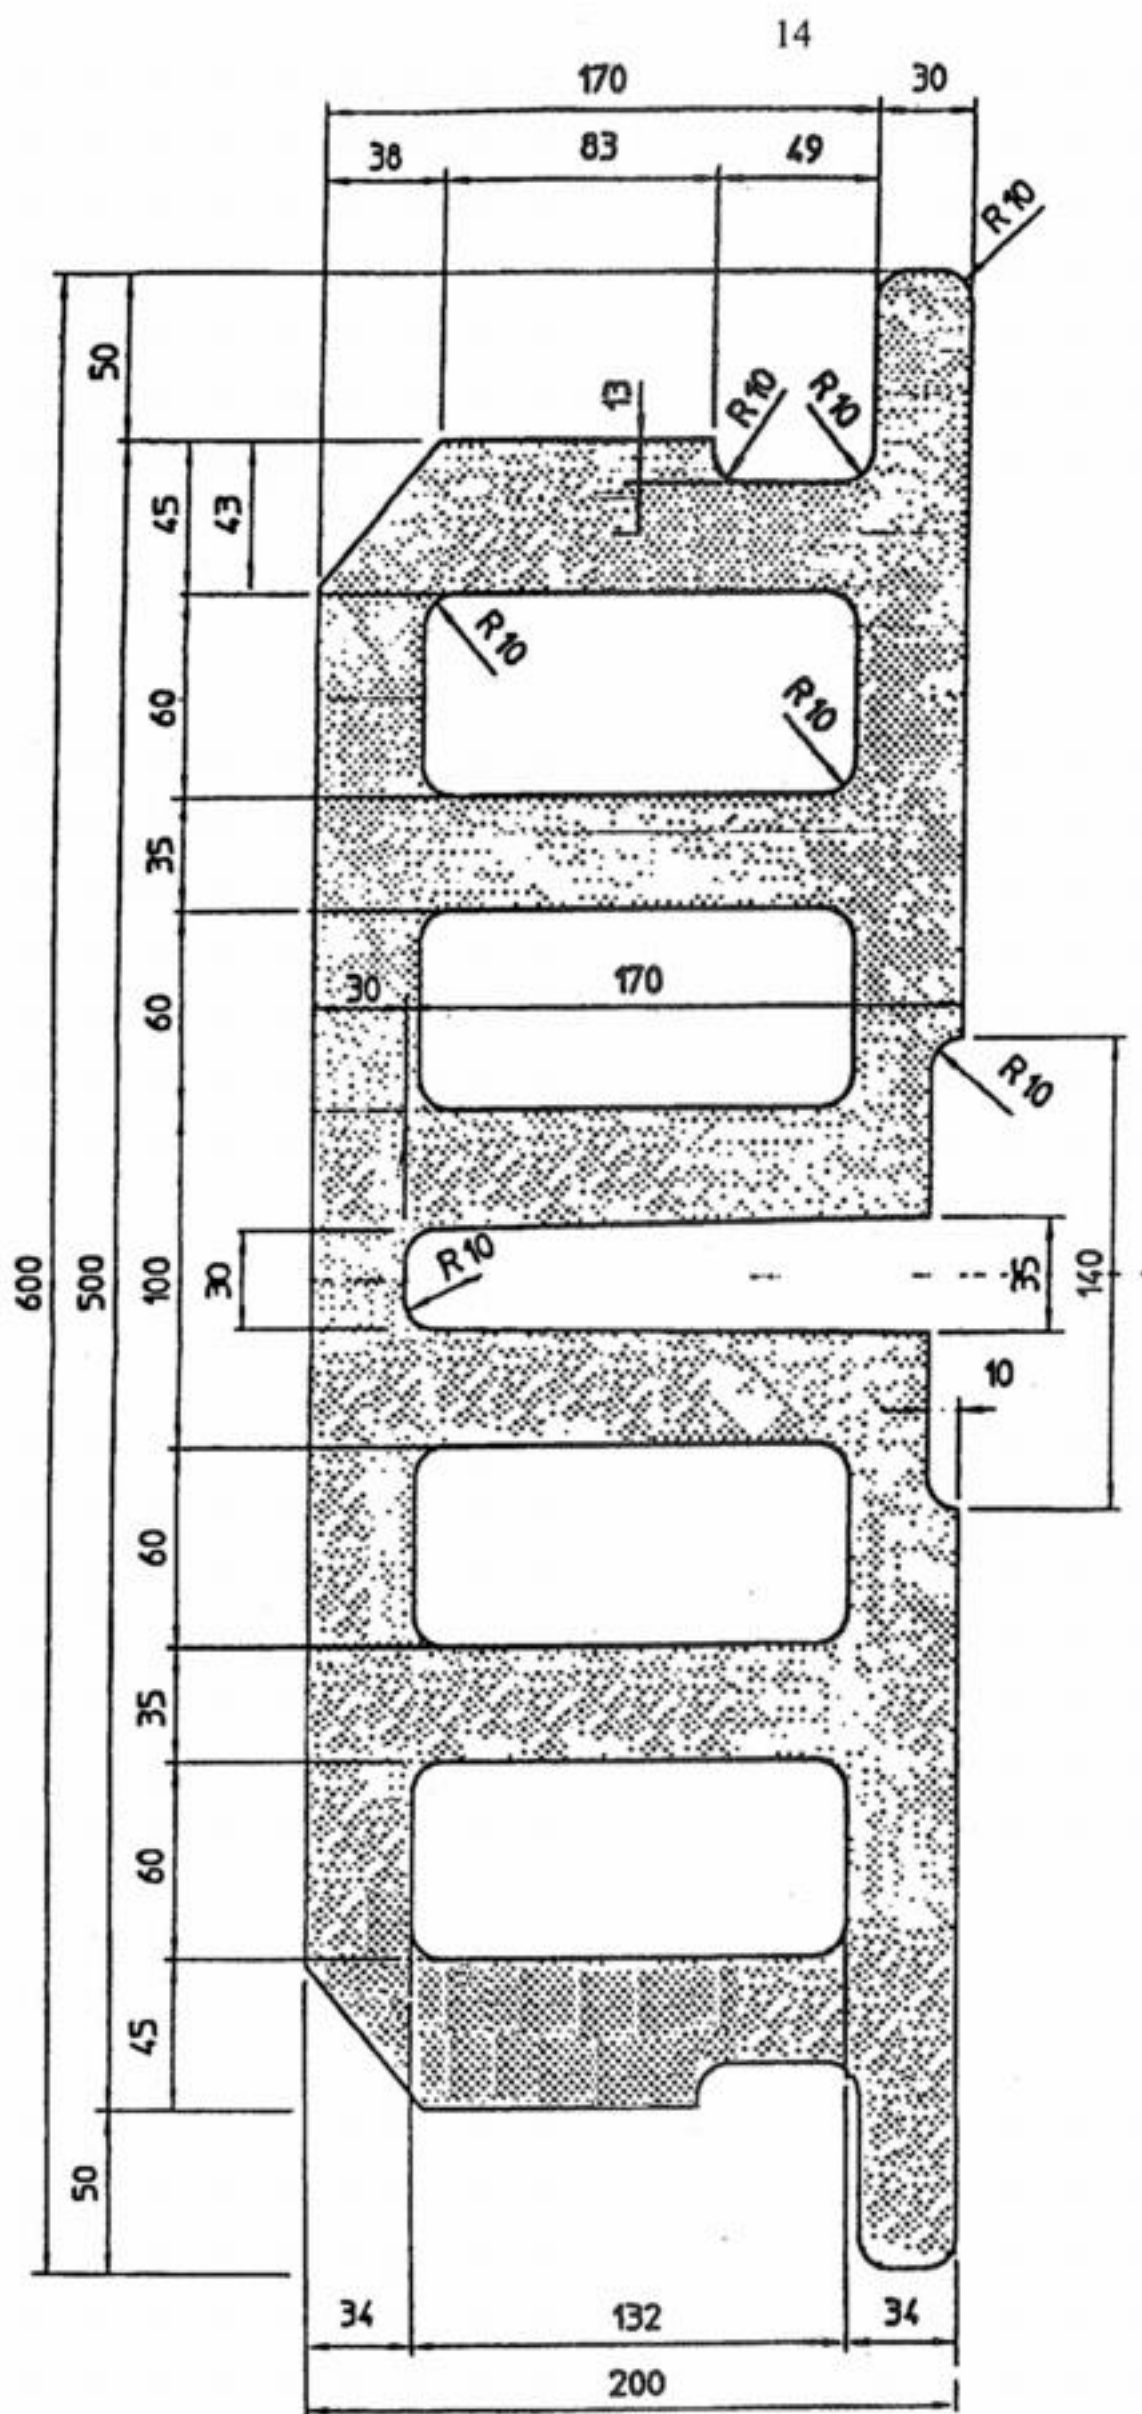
Элемент опалубочный перекрытия шириной 600 мм.
